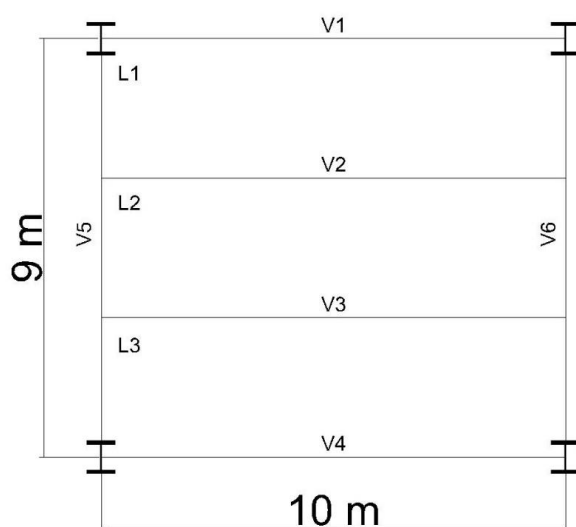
Pavimento tipo e suas dimensões (Autora (2017))
